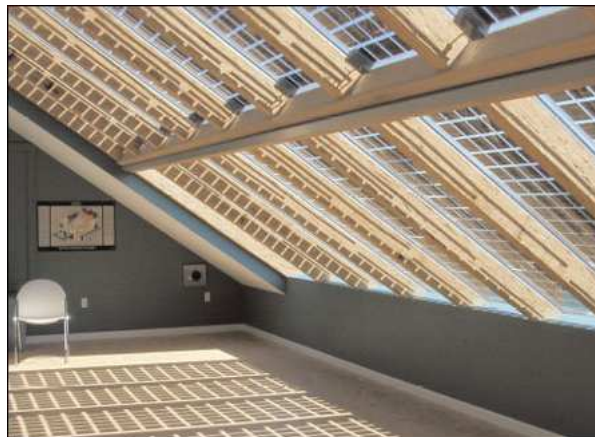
panneaux photovoltaïques à plat sur un toit, laissant apparaître les alvéoles des panneaux (sources : google image)
